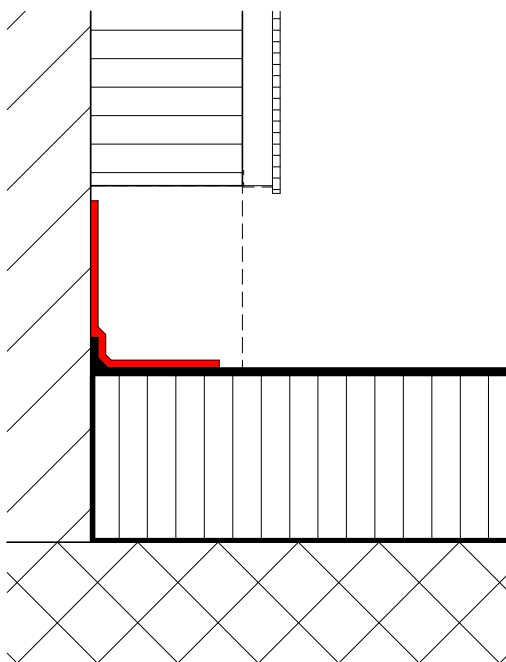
\*: Abdichtungsanschluss ohne offene Flamme z.B. Flüssigkunststoff, mit Heissluft verschweissten Bahnen.
